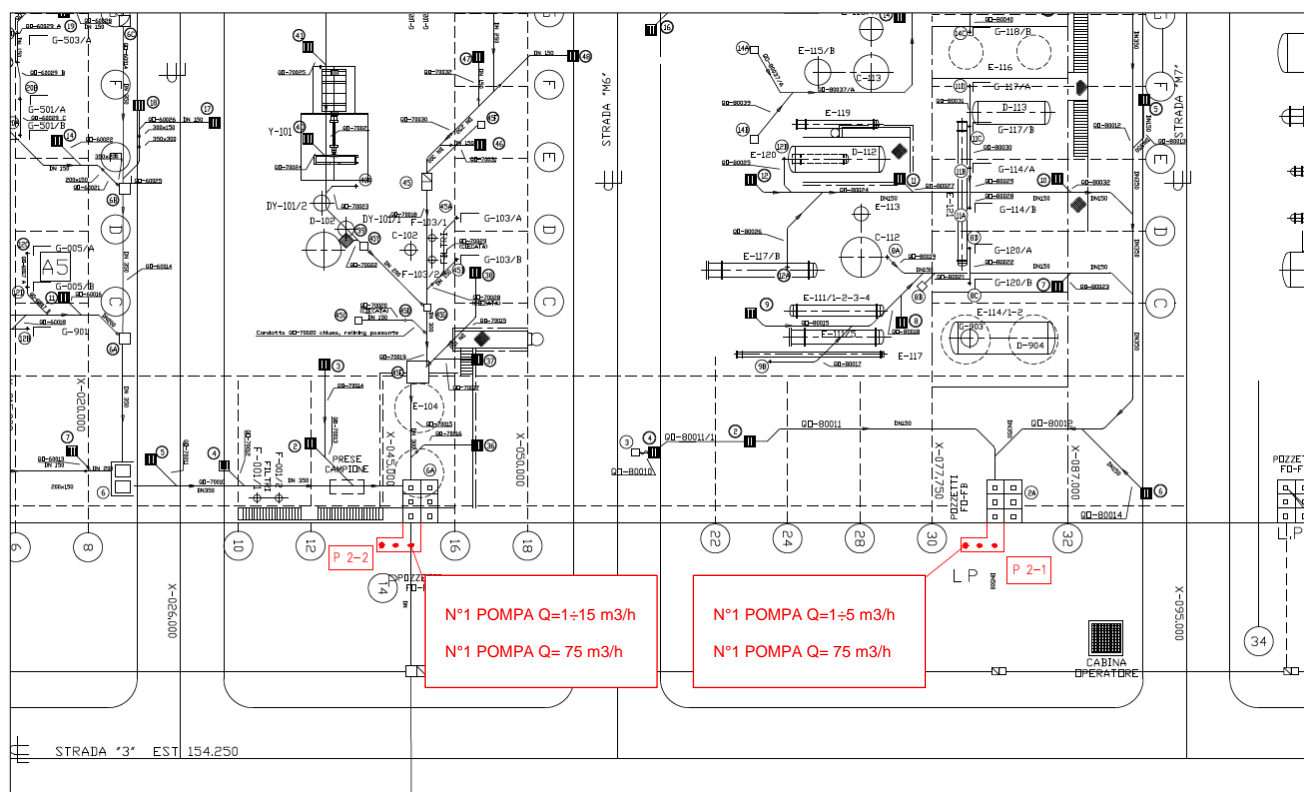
Dettaglio posizionamento planimetrico delle nuove pompe presso scarichi parziali P2-1 e P2-2
